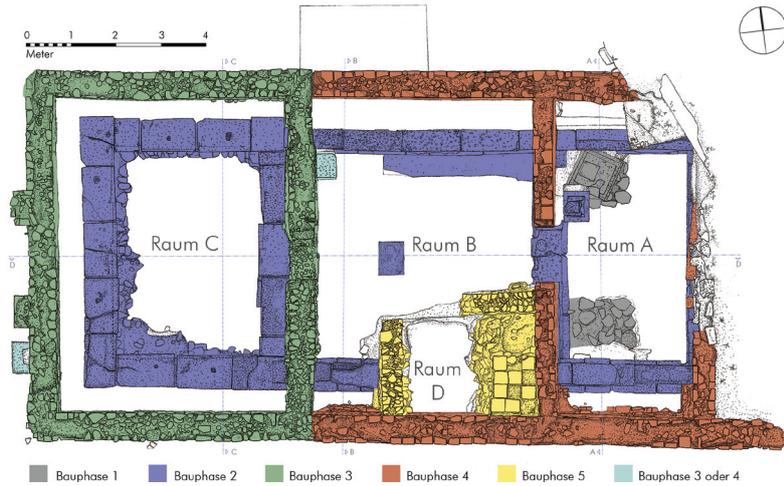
Bauphasenplan Grundriss mit Raumbezeichnungen. (siehe Anmerkung 3)
